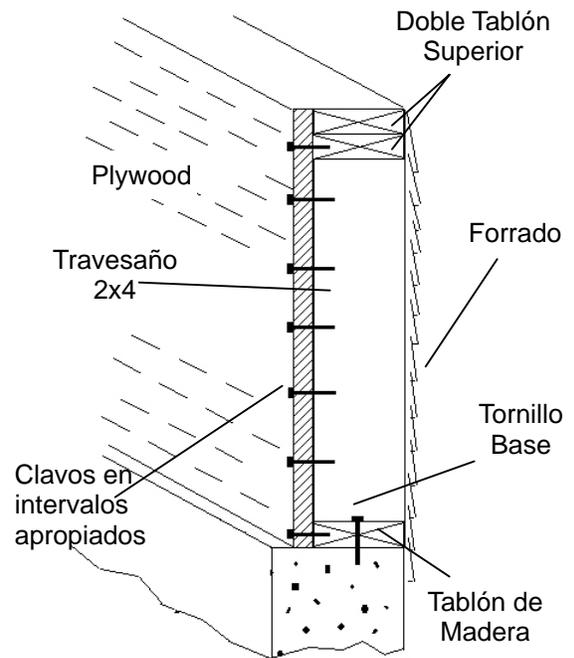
Plywood o tabla de madera en diagonal refuerza muros bajos débiles.
